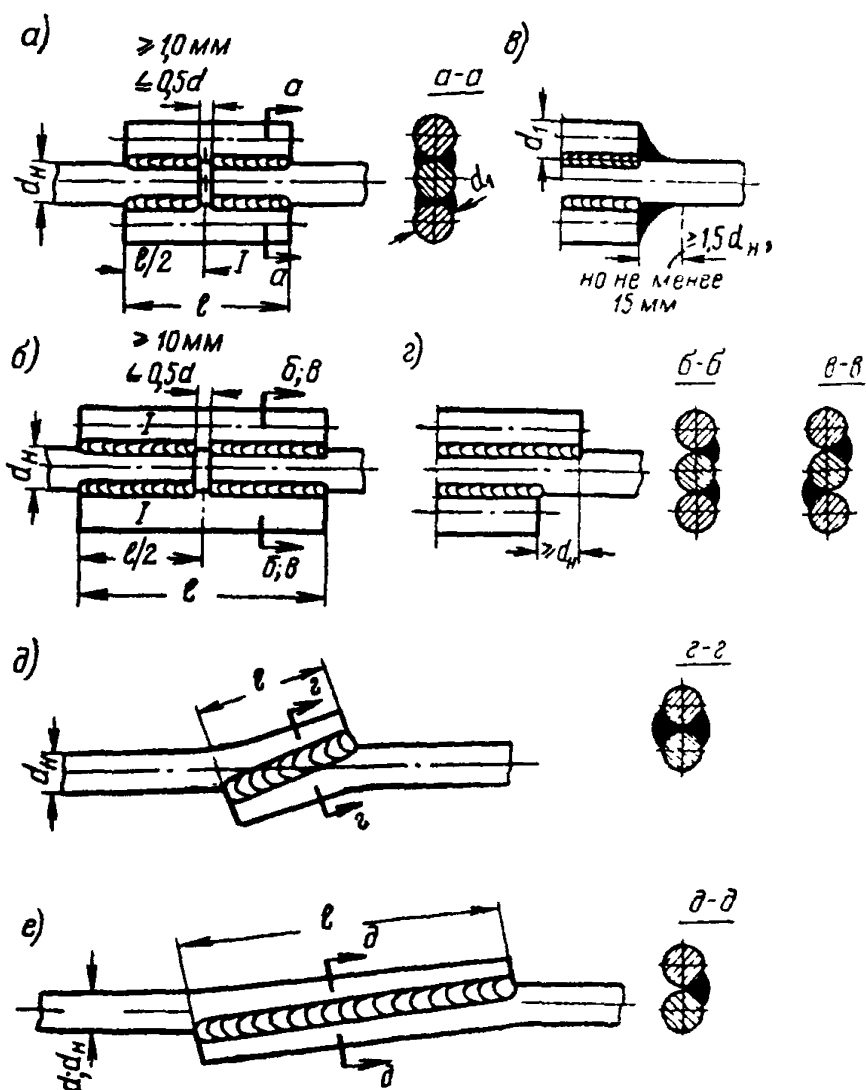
Конструкция стыковых соединений стержней, сваренных швами
